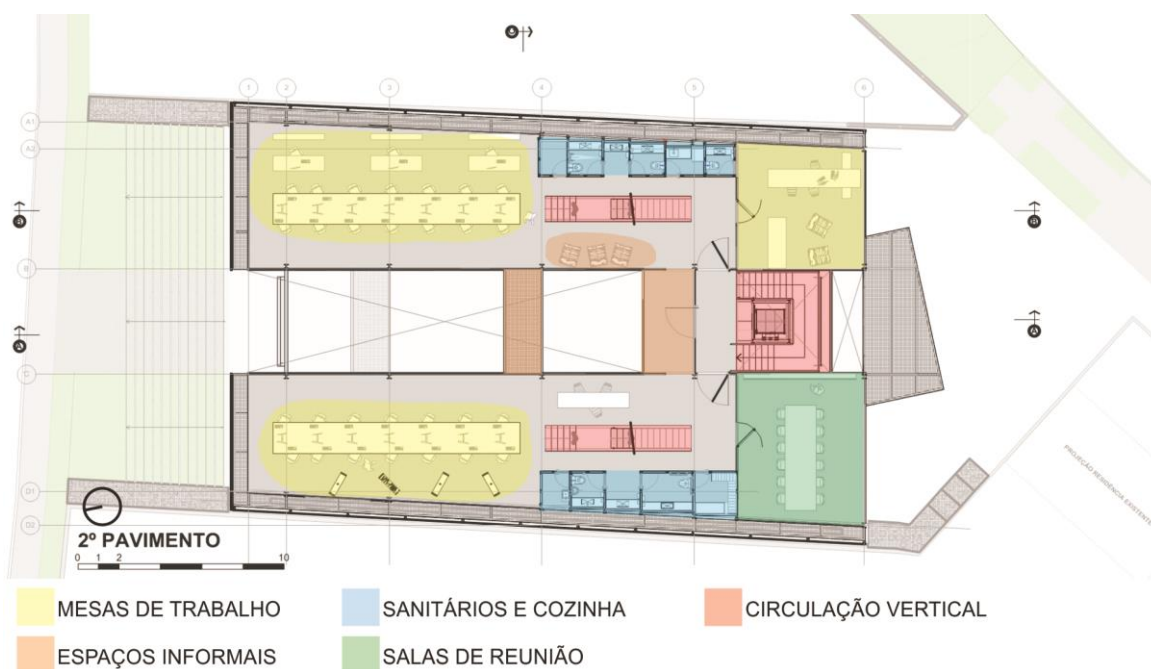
Edifício Oxi – Planta baixa do segundo pavimento.
